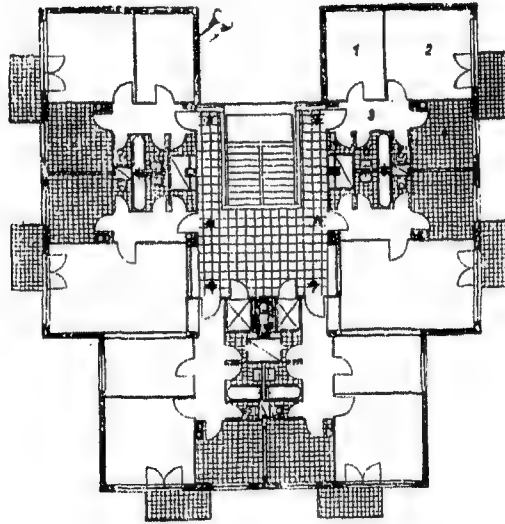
٩ - ٢ : مسقط أفقي للدور المتكرر
